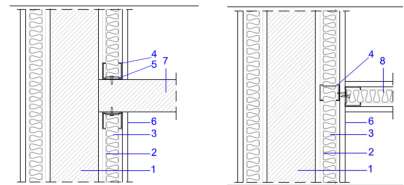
y 8 – Encuentros Tabique mixto con tabiquería interior
